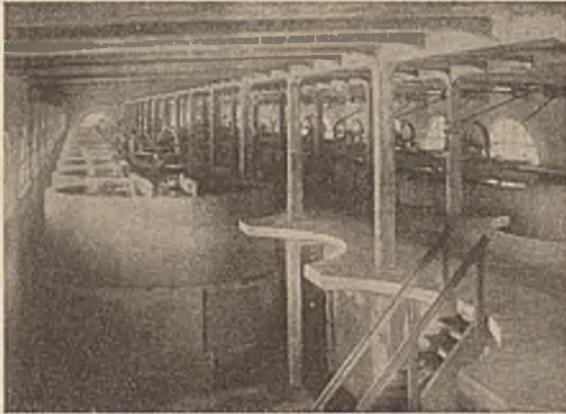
Wie 19. Blick auf die Eisenbetonfilter mit Rührwerken.
